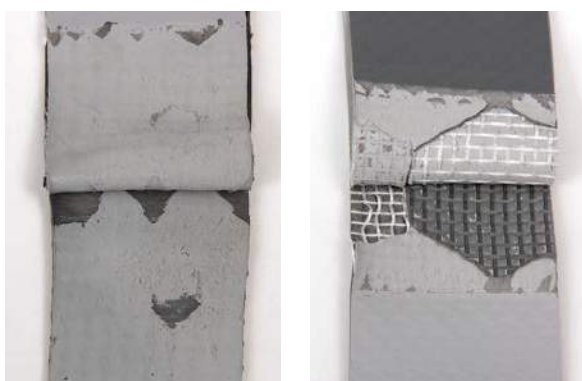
Визуальная проверка качества сварного шва
